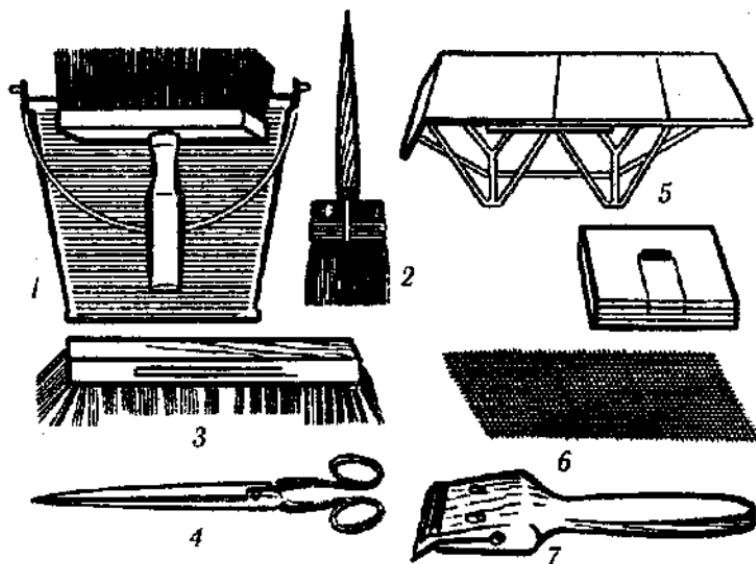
Инструменты для наклейки обоев: 1 — клейстерная щетка; 2 — клейстерная кисть; 3 — обойная щетка; 4 — обойные ножницы; 5 — обойный стол; 6 — трафаретный лоскут; 7 — цикля.
